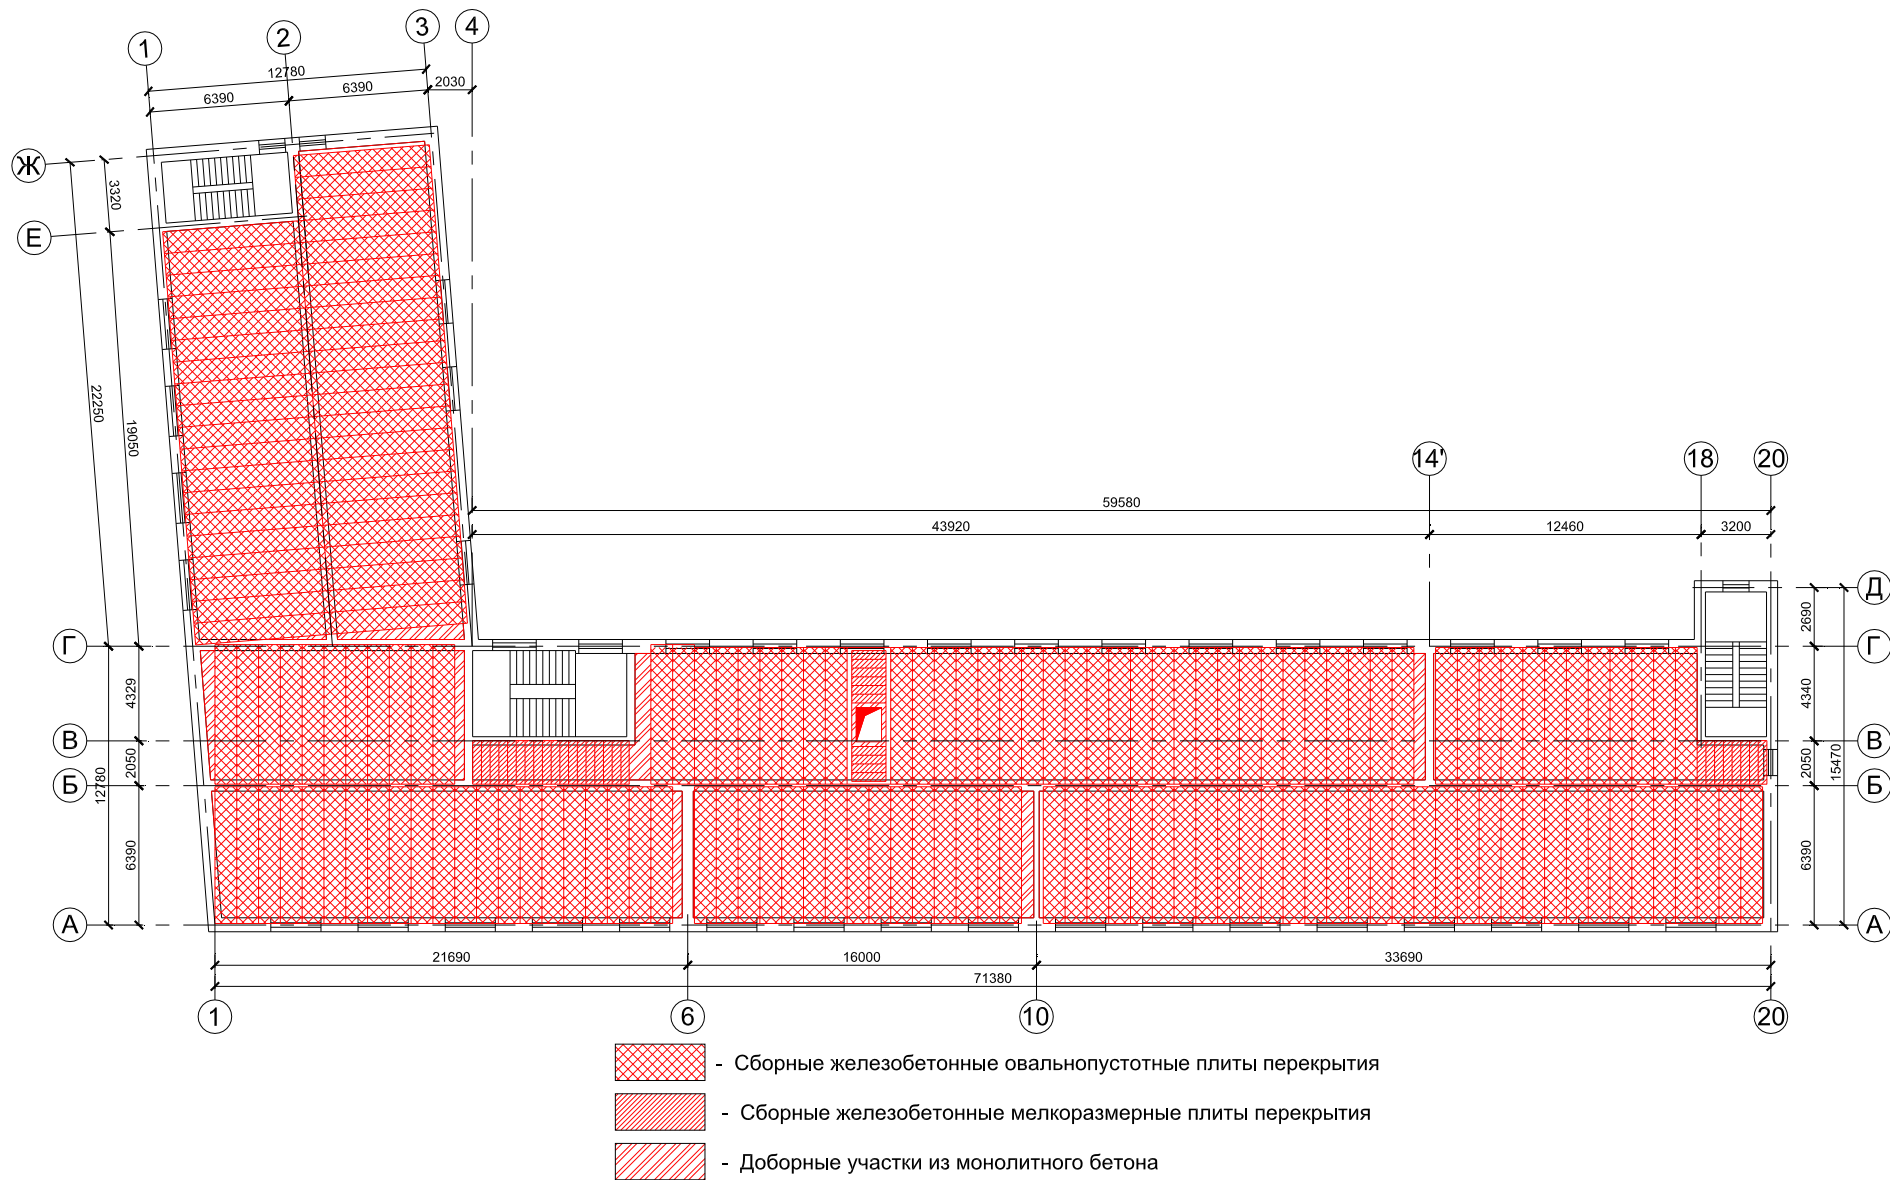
Схема раскладки плит перекрытия над вторым этажом здания.
